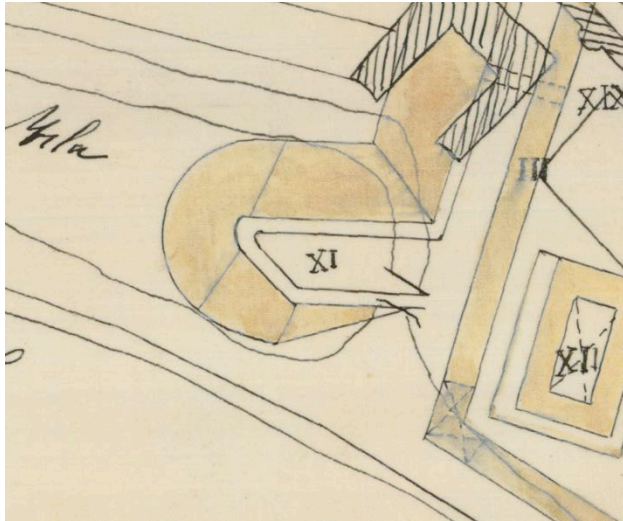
Detalle del <<Plano de 1858 con puerta (XIX) y cabeza de puente de Santa María (X)>>
